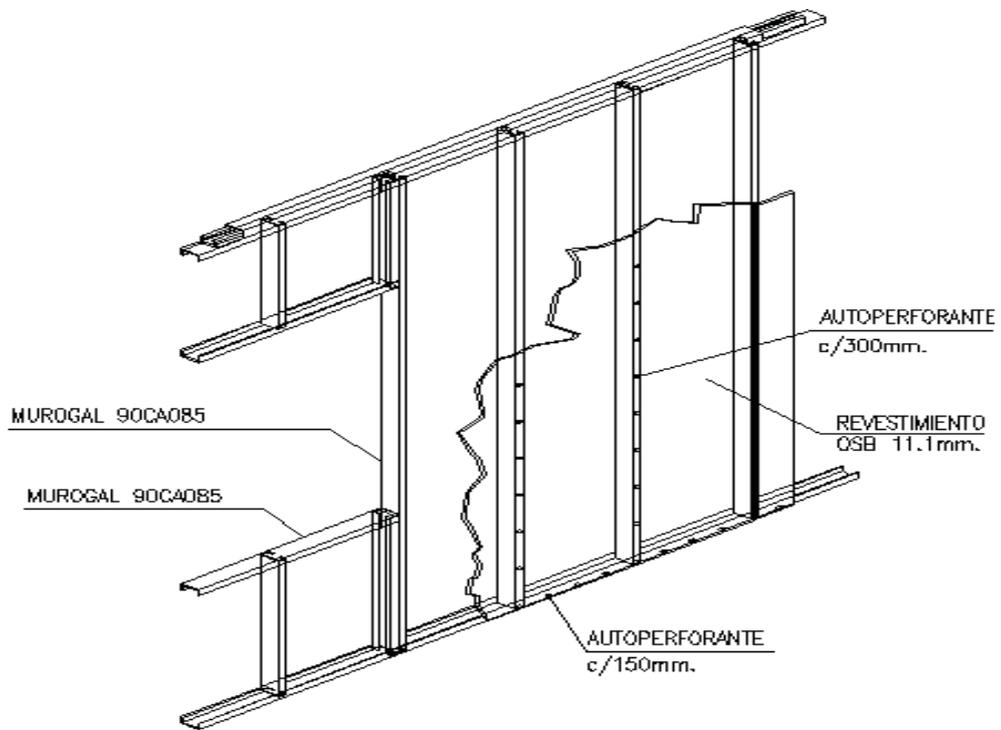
Construcción tipo de muro con perfiles de acero galvanizado.
